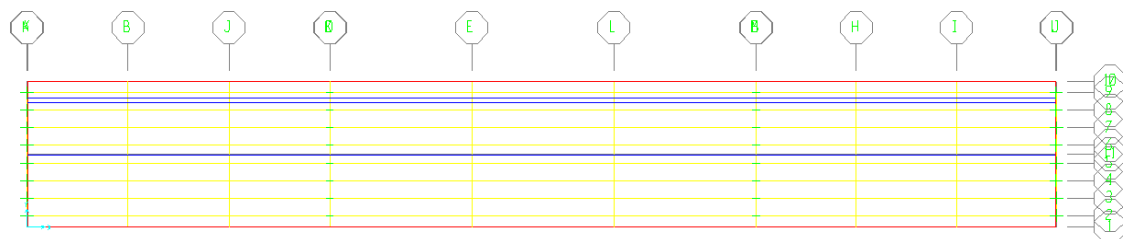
Vista en planta de las líneas de acción en la estructura (SAP2000).
